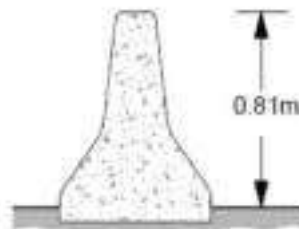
Detalle barrera New Jersey de protección Fuente: Manual de carreteras del Paraguay
